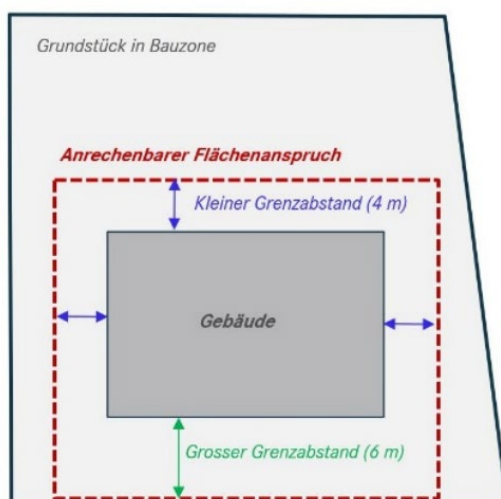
exemplarische Darstellung zur Ermittlung des anrechenbaren Flächenanspruchs für ein Gebäude in der Dorfzone
